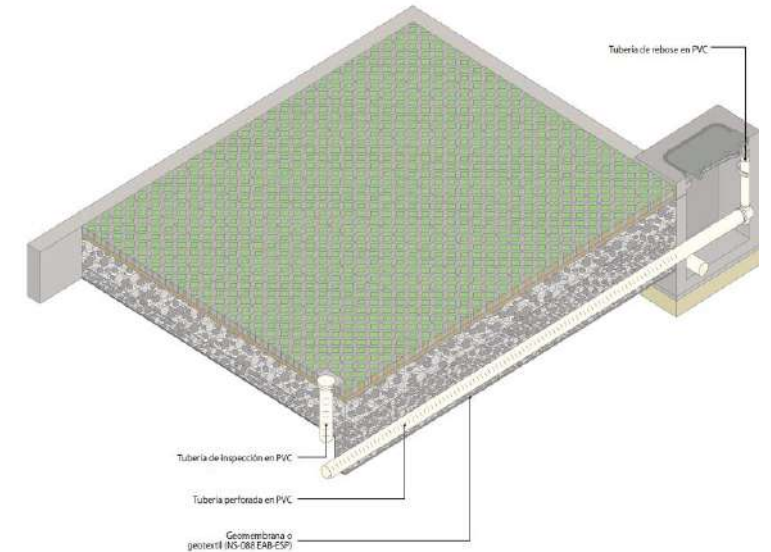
Planta: Pavimento permeable de tipo adoquines entrelazados
